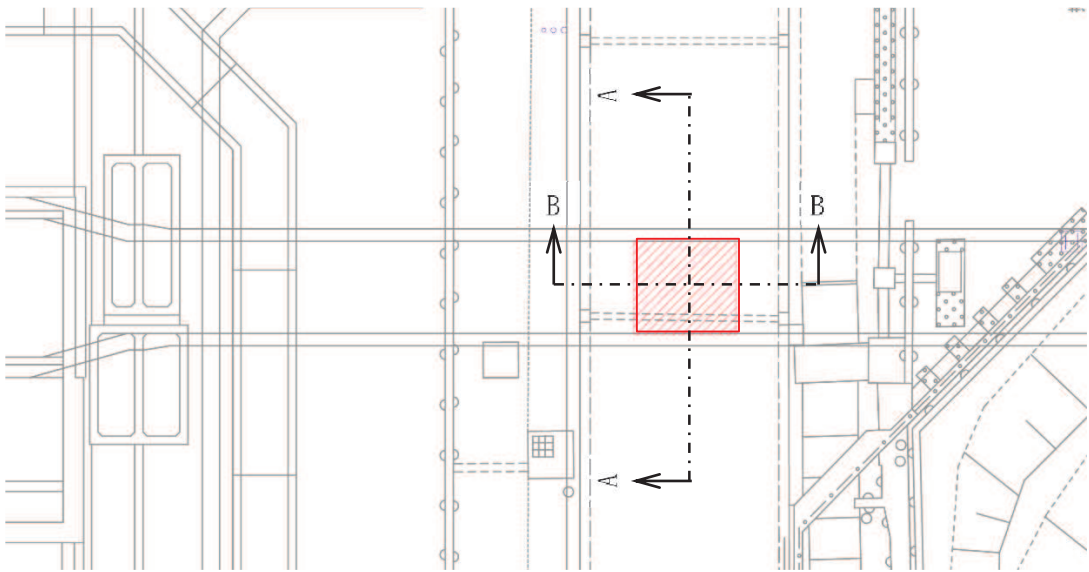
(1) 取放水路流路縮小工（第1号機放水路） 平面図
